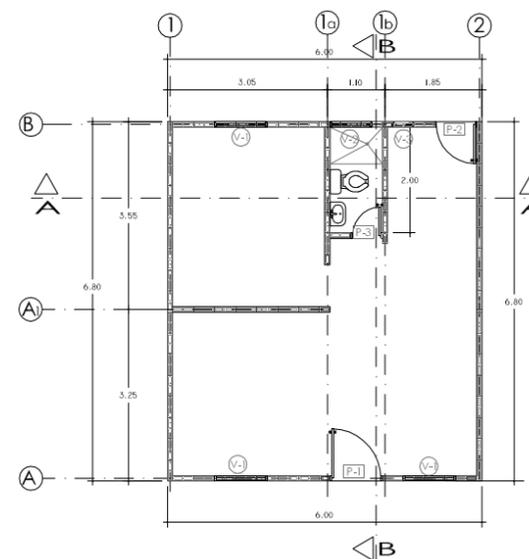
Esquema de planta arquitectónica de vivienda de bloque de concreto.
